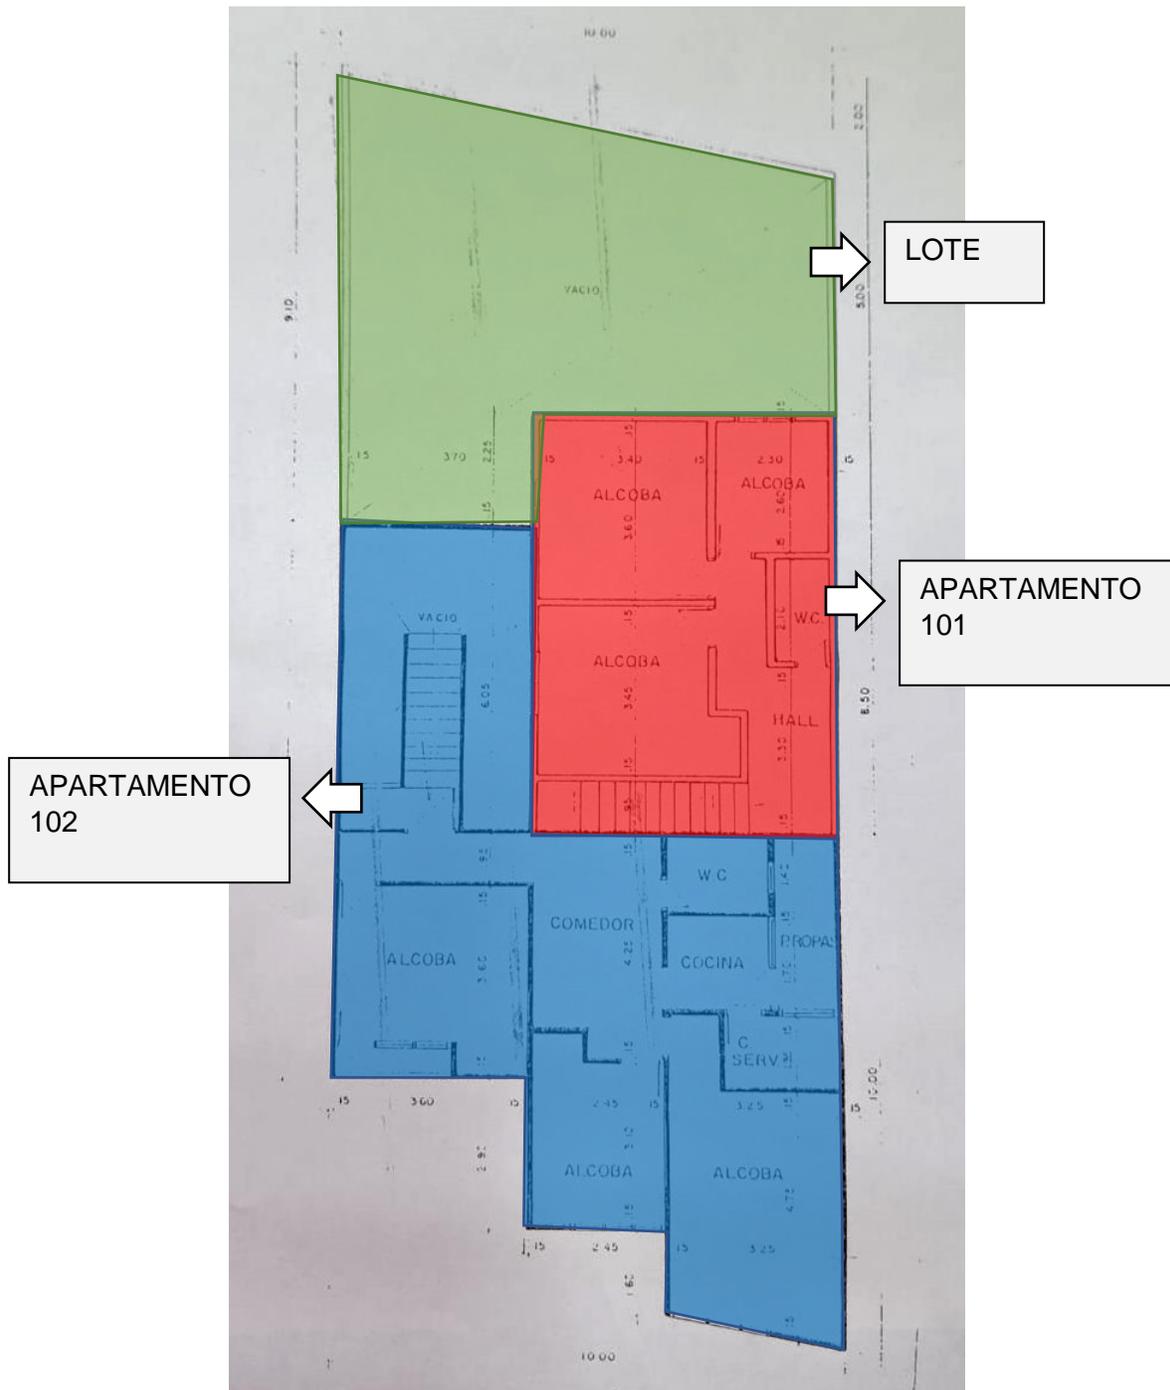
Planimetría segundo piso, lote general. Fuente: Escritura pública No 899
